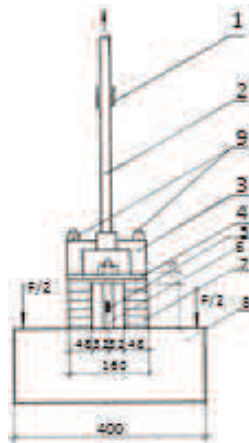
Схема испытаний клеевых соединений динамической нагрузкой: 1 - захват прессы; 2 - стальная тяга; 3- серьга; 4 - станина оборудования; 5 - тензорезисторы, 6 - анкерный болт; 7 - подкладки; 8 - бетонный образец; 9 – стяжные болты
